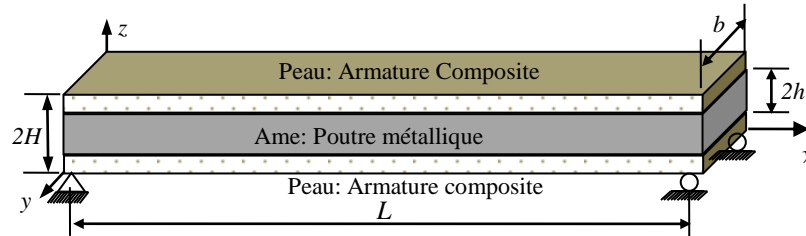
Renforcement sur les deux côtés de la poutre (sandwich)
